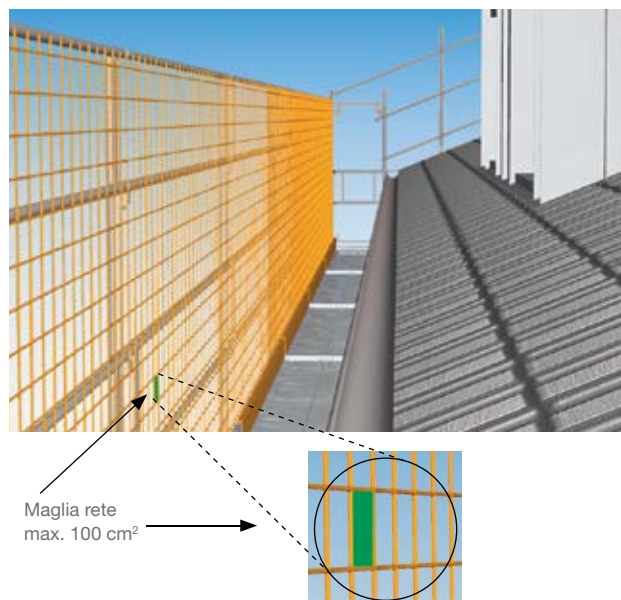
ponte da lattoniere con parete di protezione da copritetto, variante con griglia per tutta l'altezza
